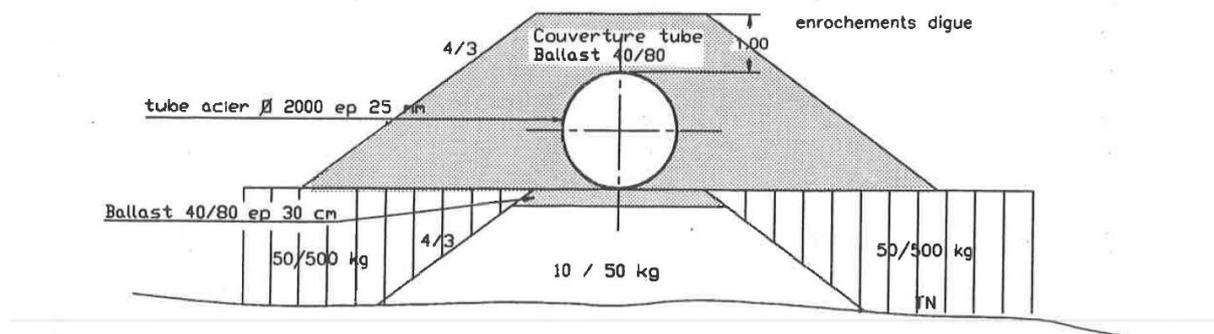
Coupe transversale émissaire sous l'emprise de la digue (source Plan d'exécution Émissaire sous digue SPADA 1993)
